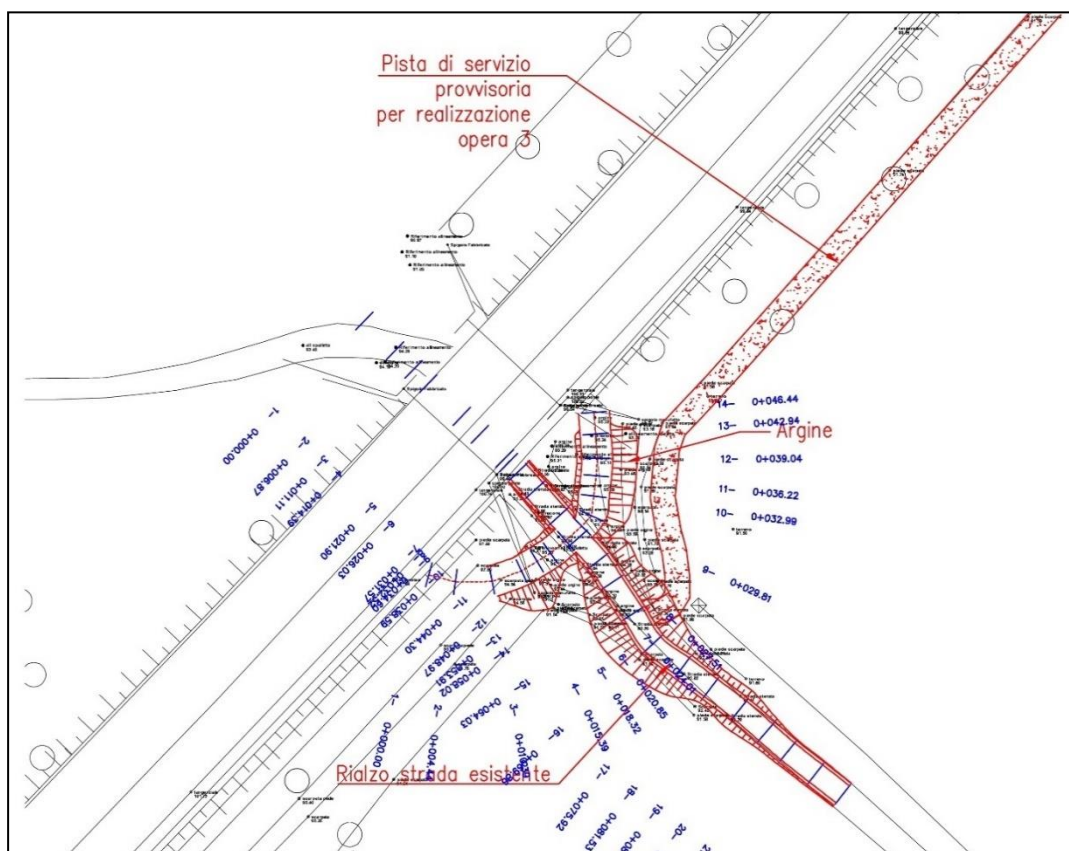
Arginatura chiusura fornice ramo nord Via del Chiozzetto – Planimetria
